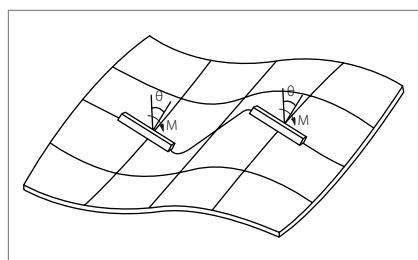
Compatibilidade de deslocamentos entre laje do pavimento e pilares parede.
